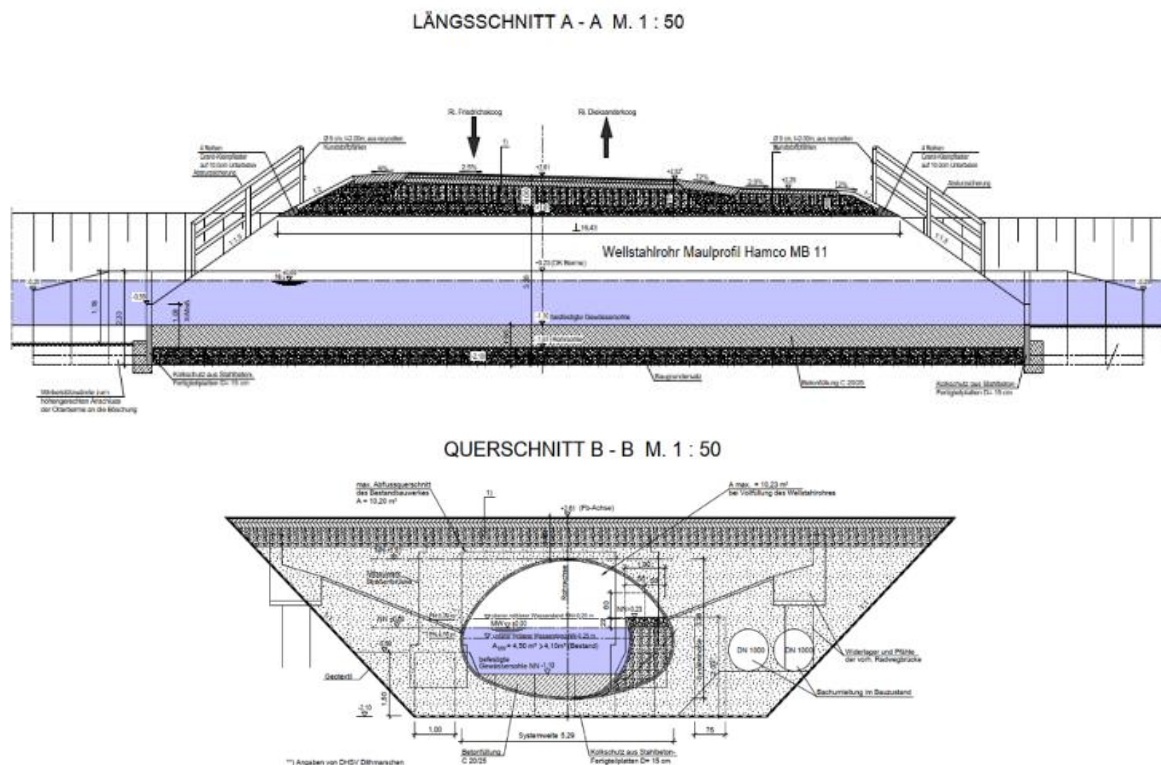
Straßenbrücke über Gewässer aus Wellstahlrohr Maulprofil mit einer Spannweite von 5,3 m - Planung © Büro Mohn, 2018
